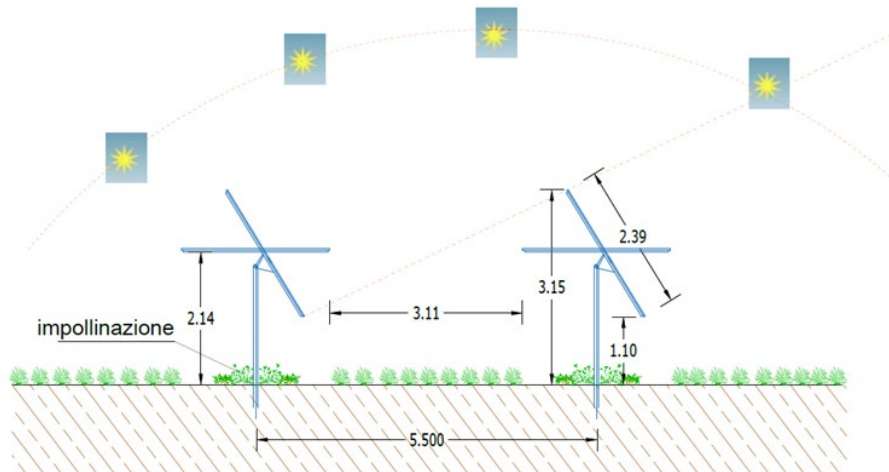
Sezione lotto d'impianto con tracker 1V30 e 1V15
